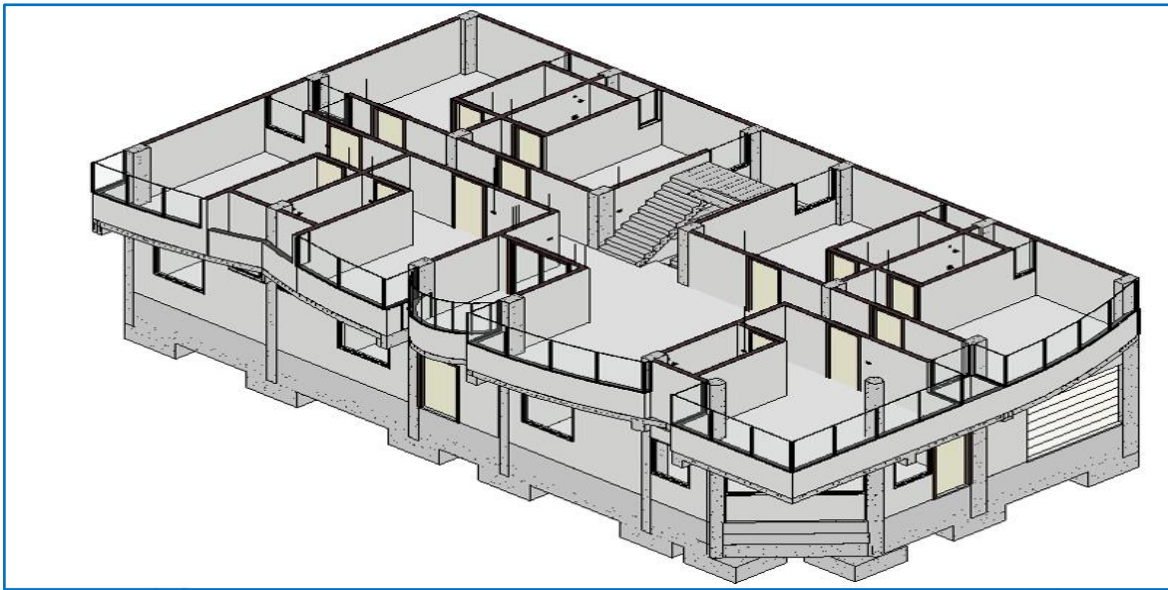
Vista 3D de losa en ladrillo y concreto en Revit
